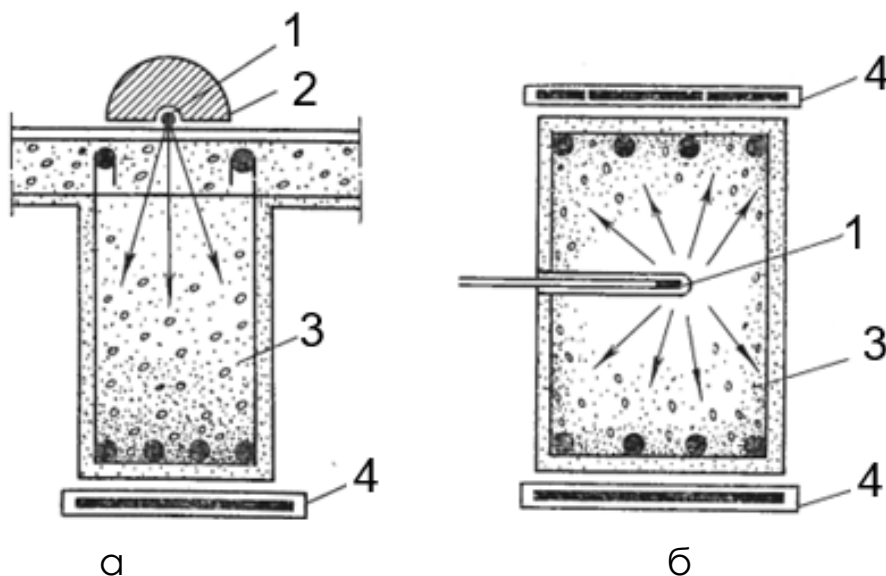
Схема контролю розміщення арматури в залізобетонних виробках при зовнішньому розміщенні ізоотопу (а) та при розміщенні ізоотопу всередині конструкції (б):
